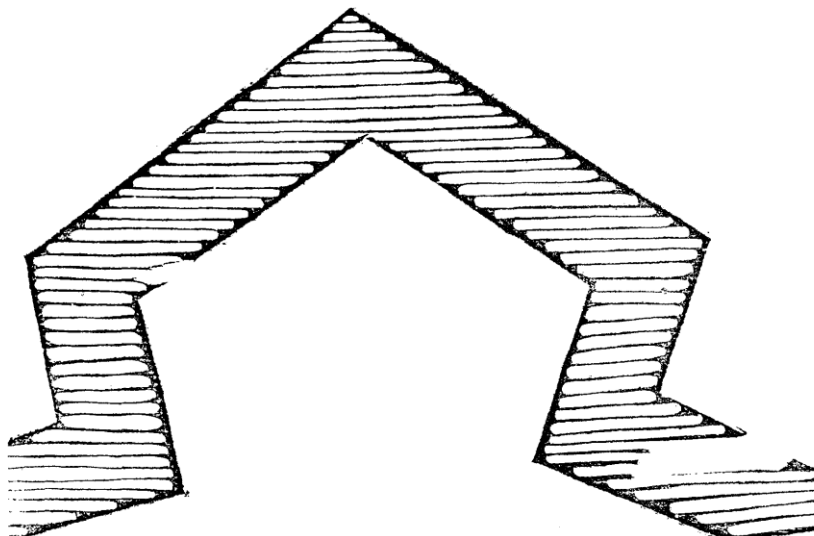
Trabajo de madera en las fortificaciones. Colocación de la madera en la cimentación de las murallas.⁸⁹⁰
